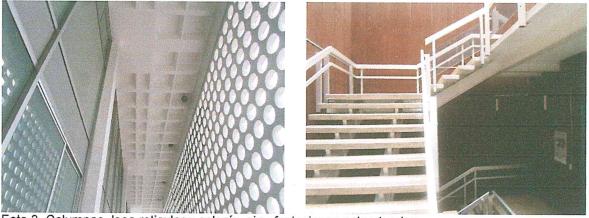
Columnas, losa reticular y celosía, sin afectaciones estructurales. Foto 4. Escalera de estructura metálica, sin afectaciones estructurales.
